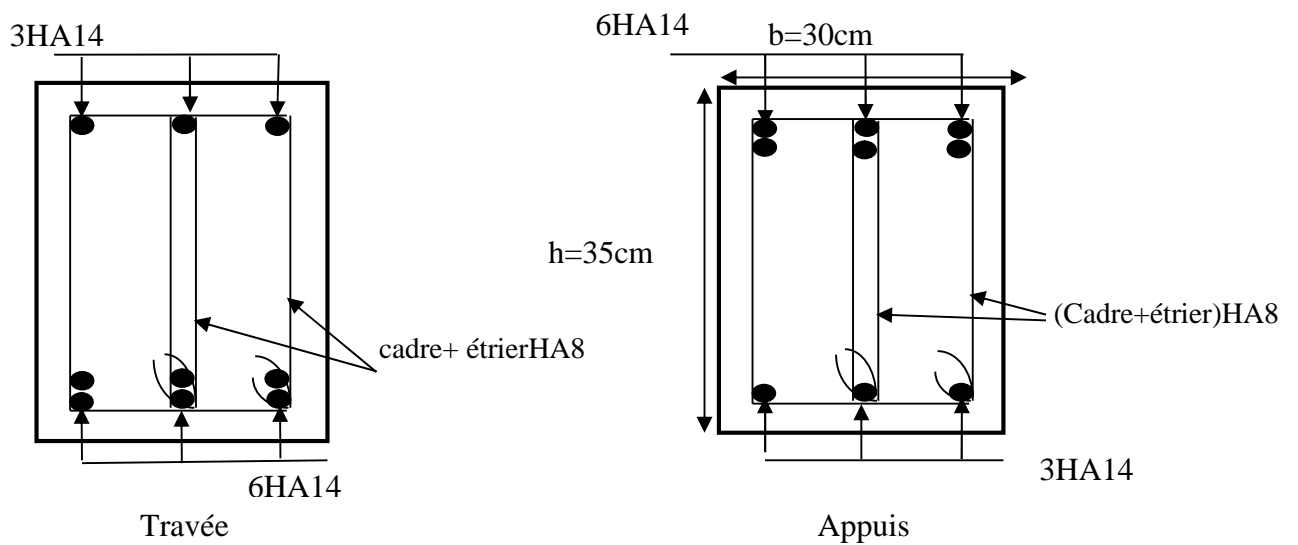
schémas de ferrailage des poutres secondaires (RDC, étage service, 1étage)
